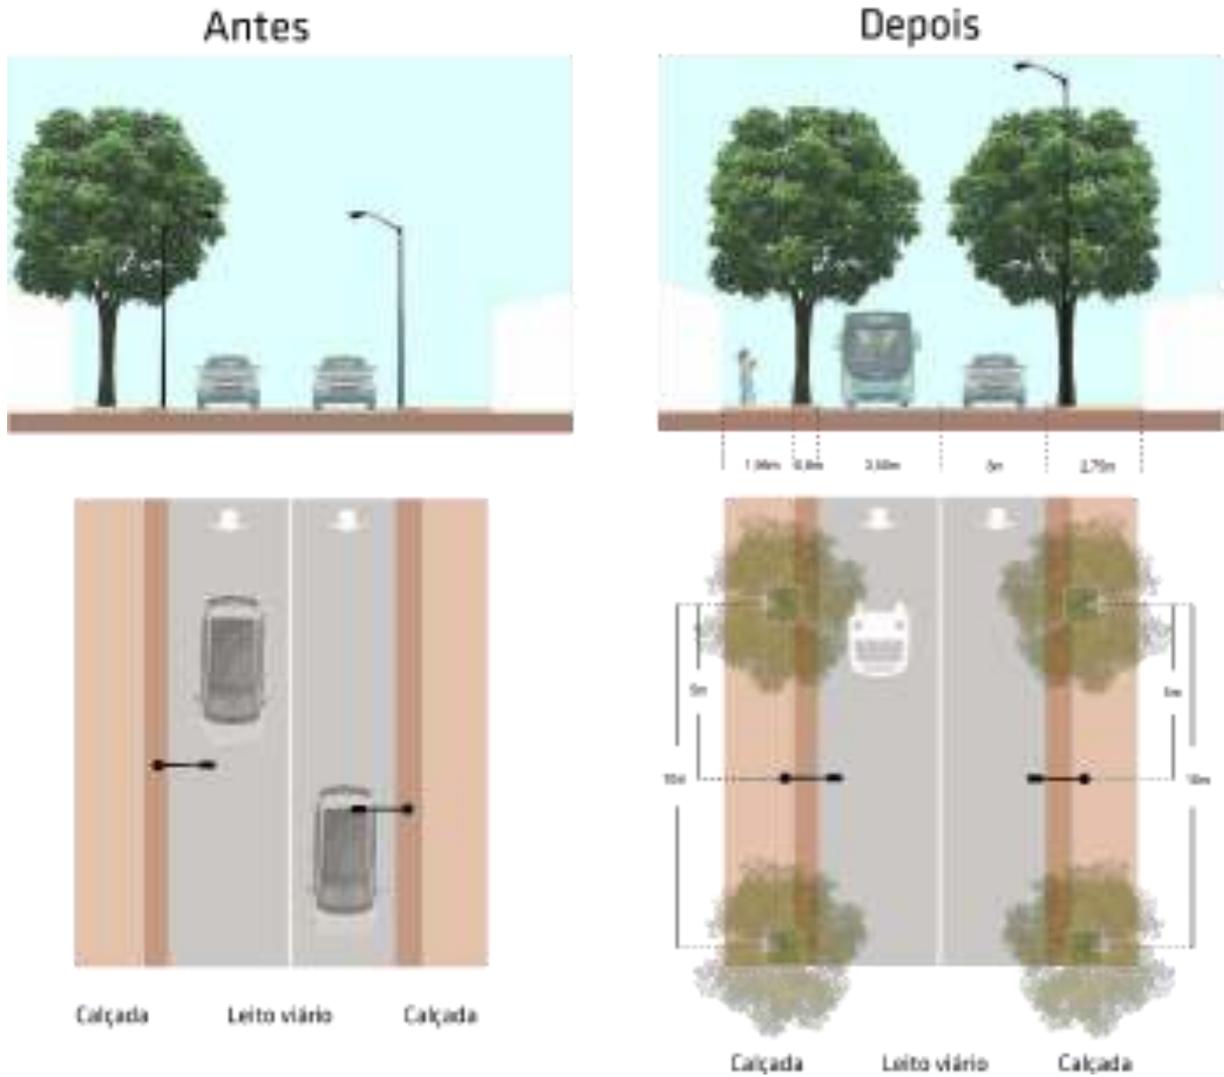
Proposta para a Seção C - Rua José Sabóia. Fonte: Architectus.
